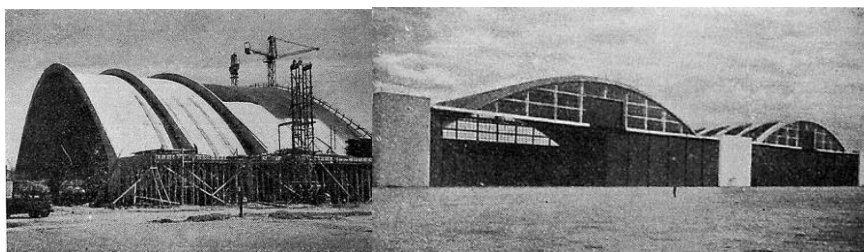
Construcción de los Hangares. Fuente: Revista Construcciones n° 126
